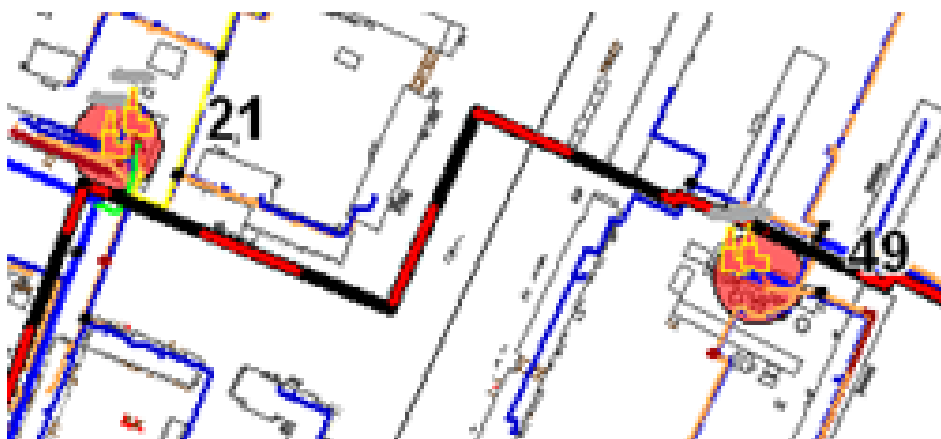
Схема прокладки трубопровода между котельными №21 и №49
